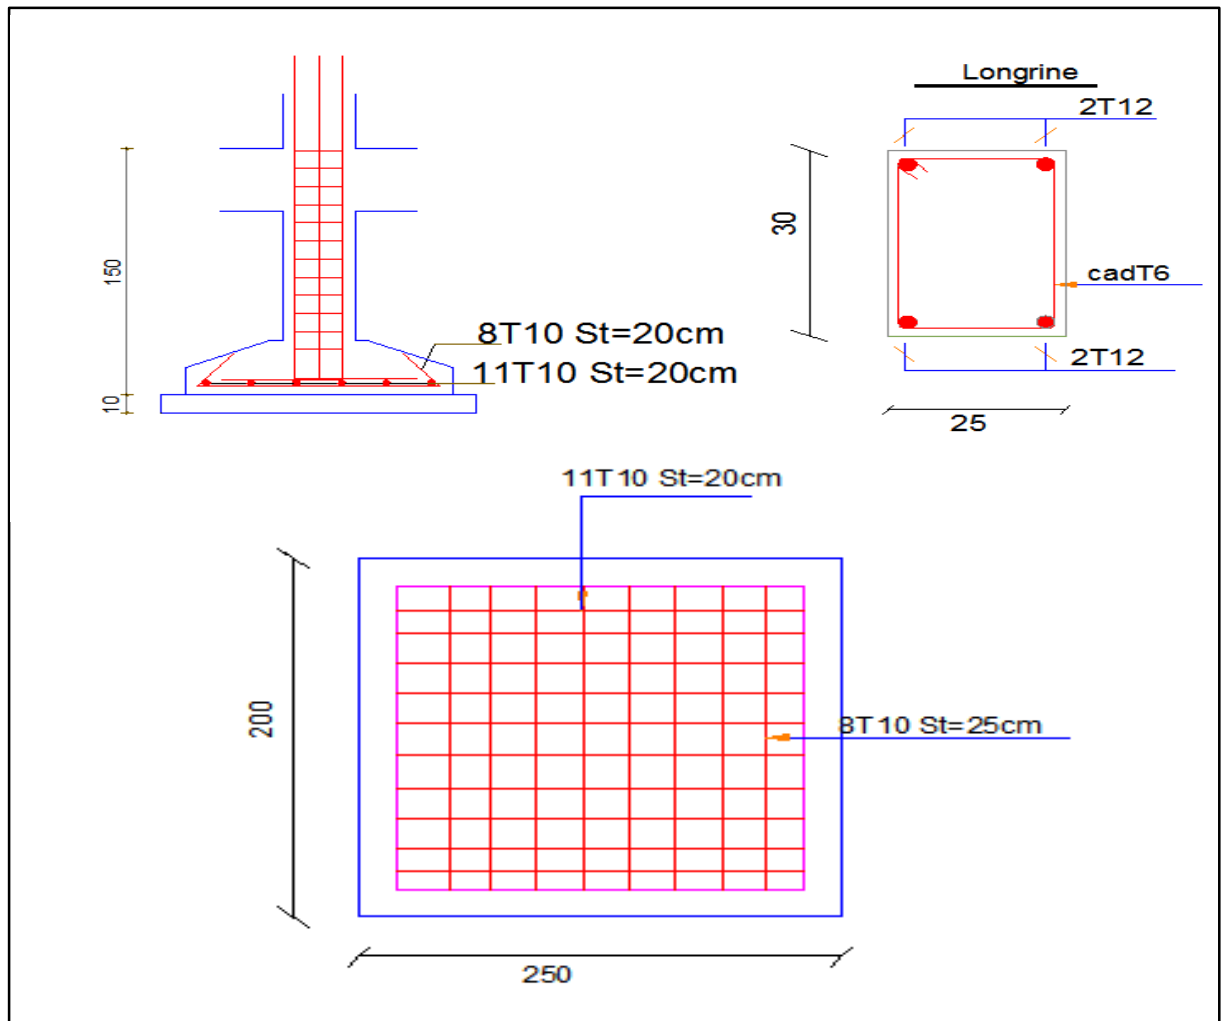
4 : schémas de ferrailage de la semelle isolée Type2
